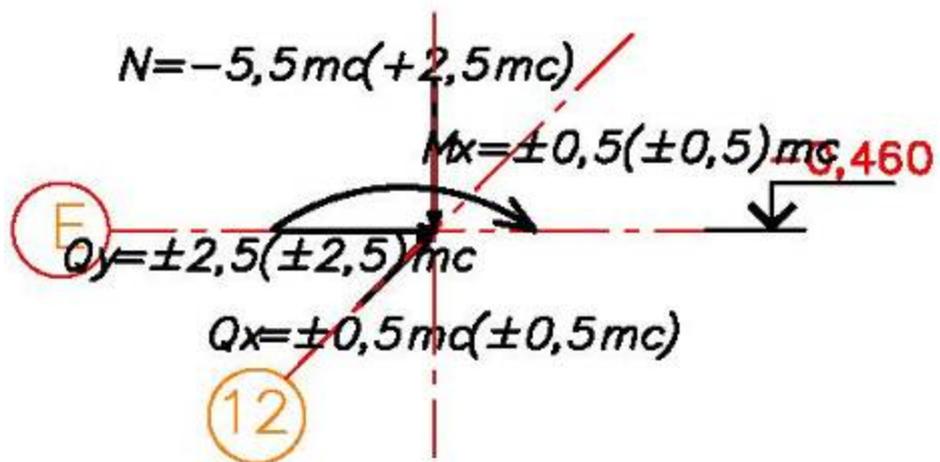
Схема нагрузок на фундамент ФМЗ
